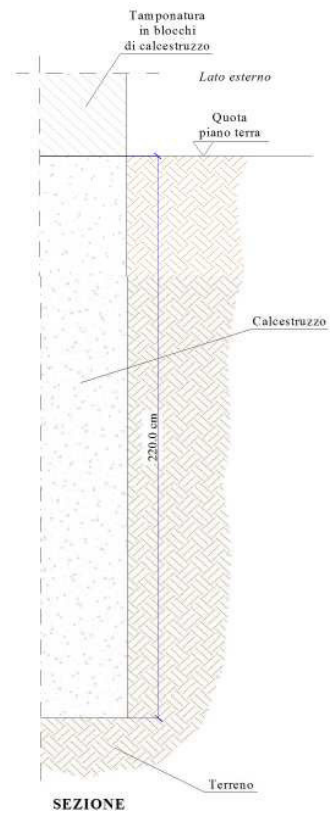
Indagine SF1 (saggio in fondazione) del Blocco A: è stata rilevata una fondazione in cls di altezza pari a 220 cm.
